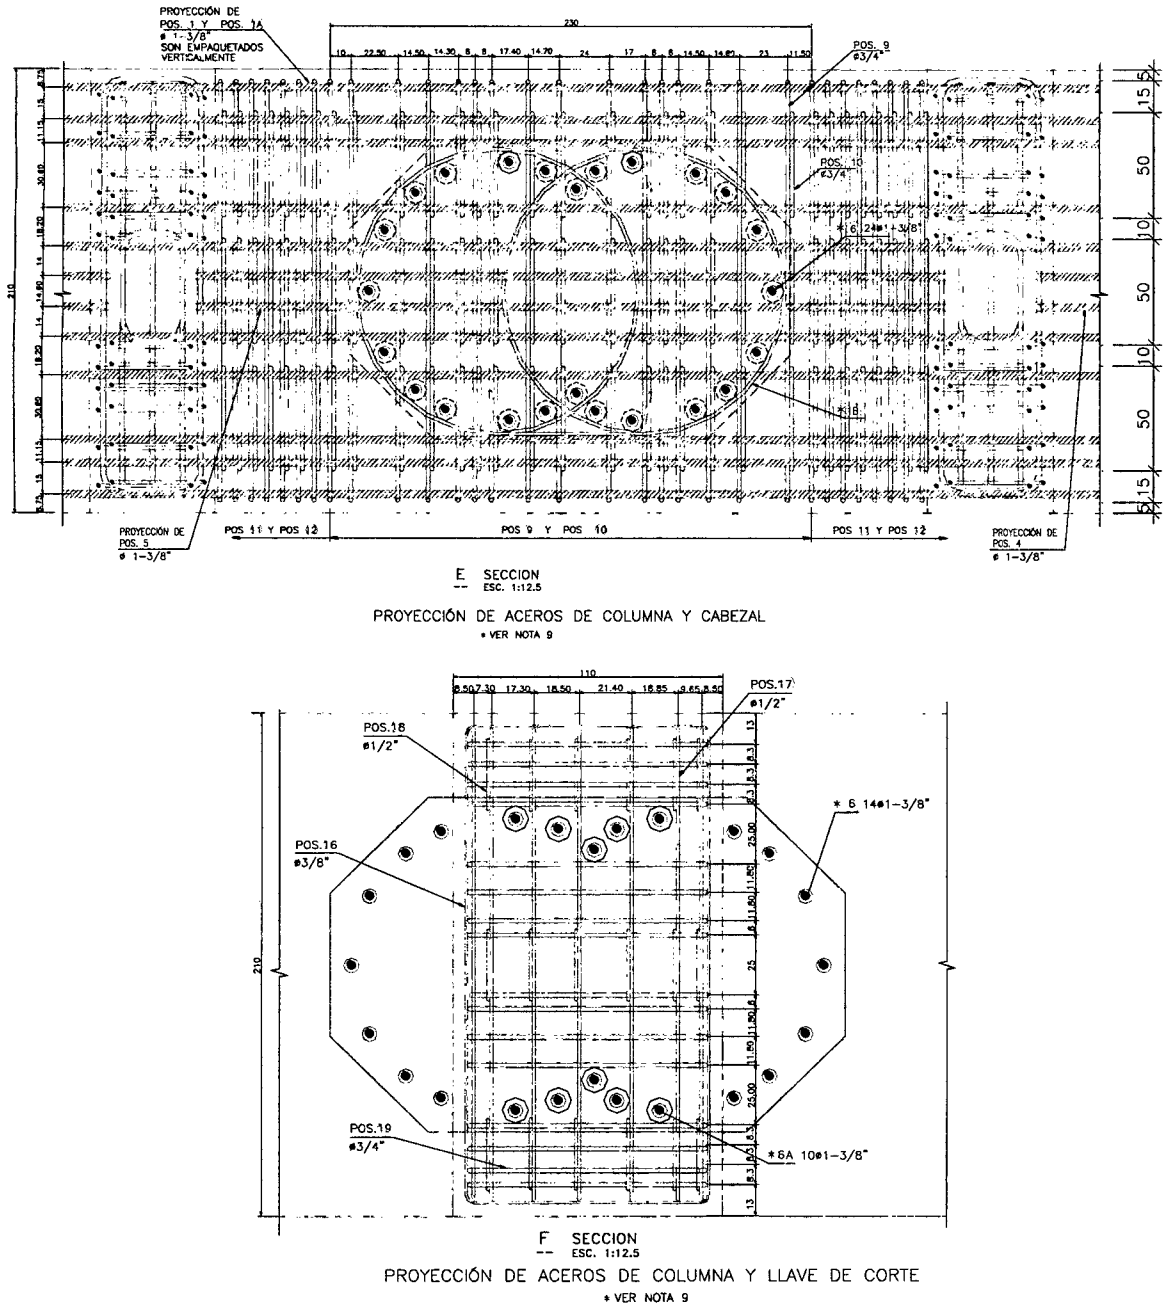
Detalle de proyección de acero de columna, viga cabezal y llave de corte.
